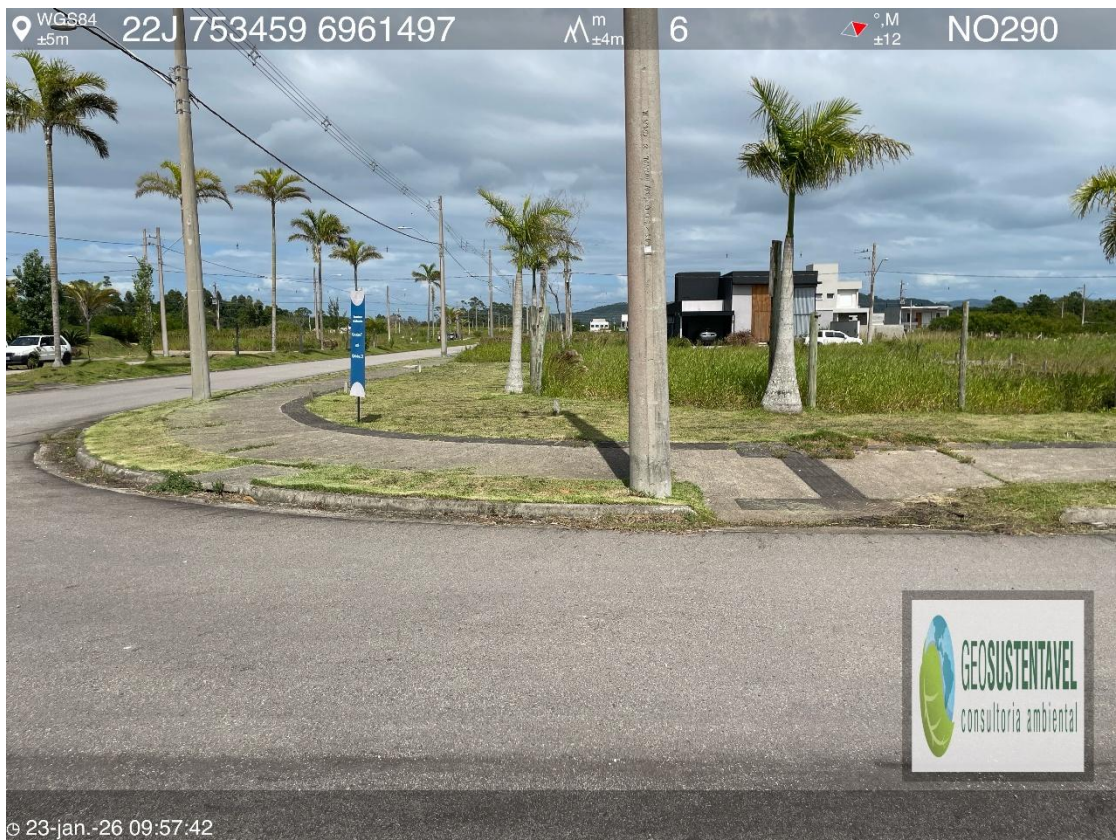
O passeio em concreto possui rebaixos de meio-fio equipados com piso tátil de alerta e direcional.
